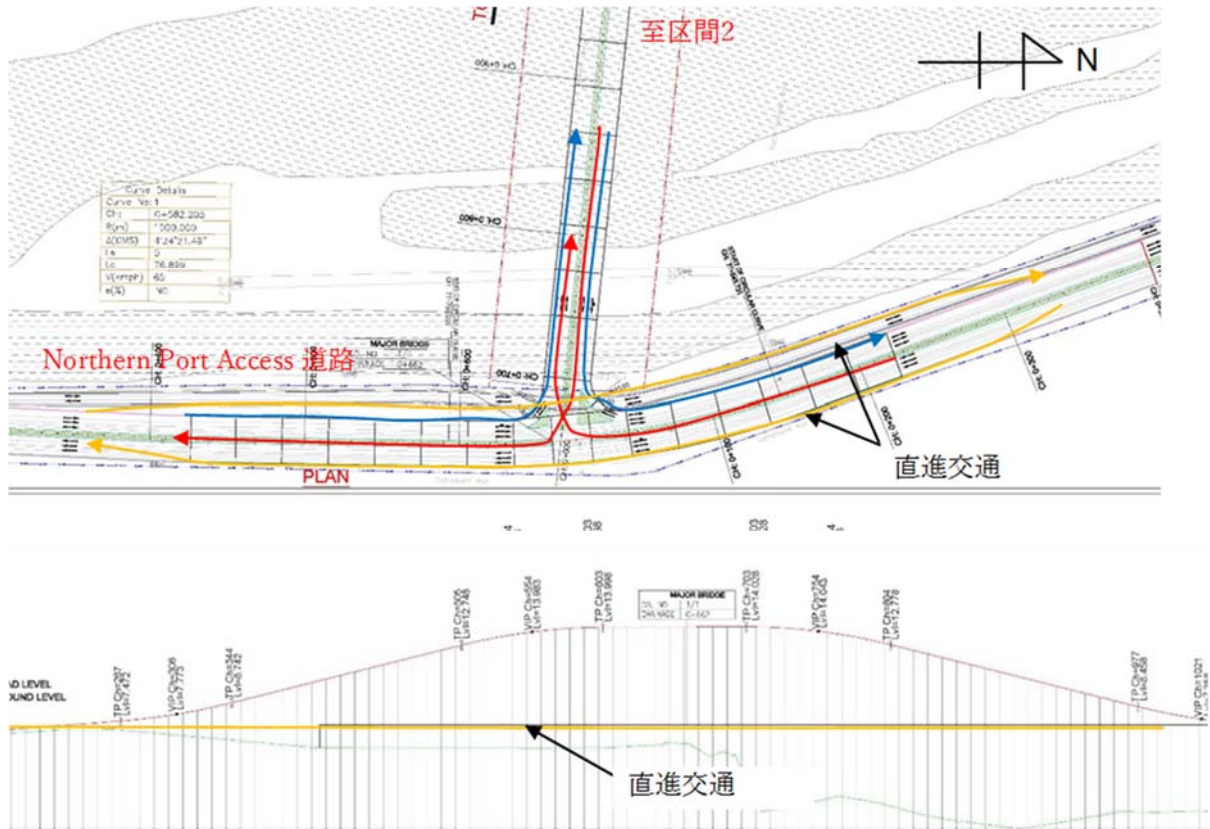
JCT-1 計画図(平面図・縦断図)
